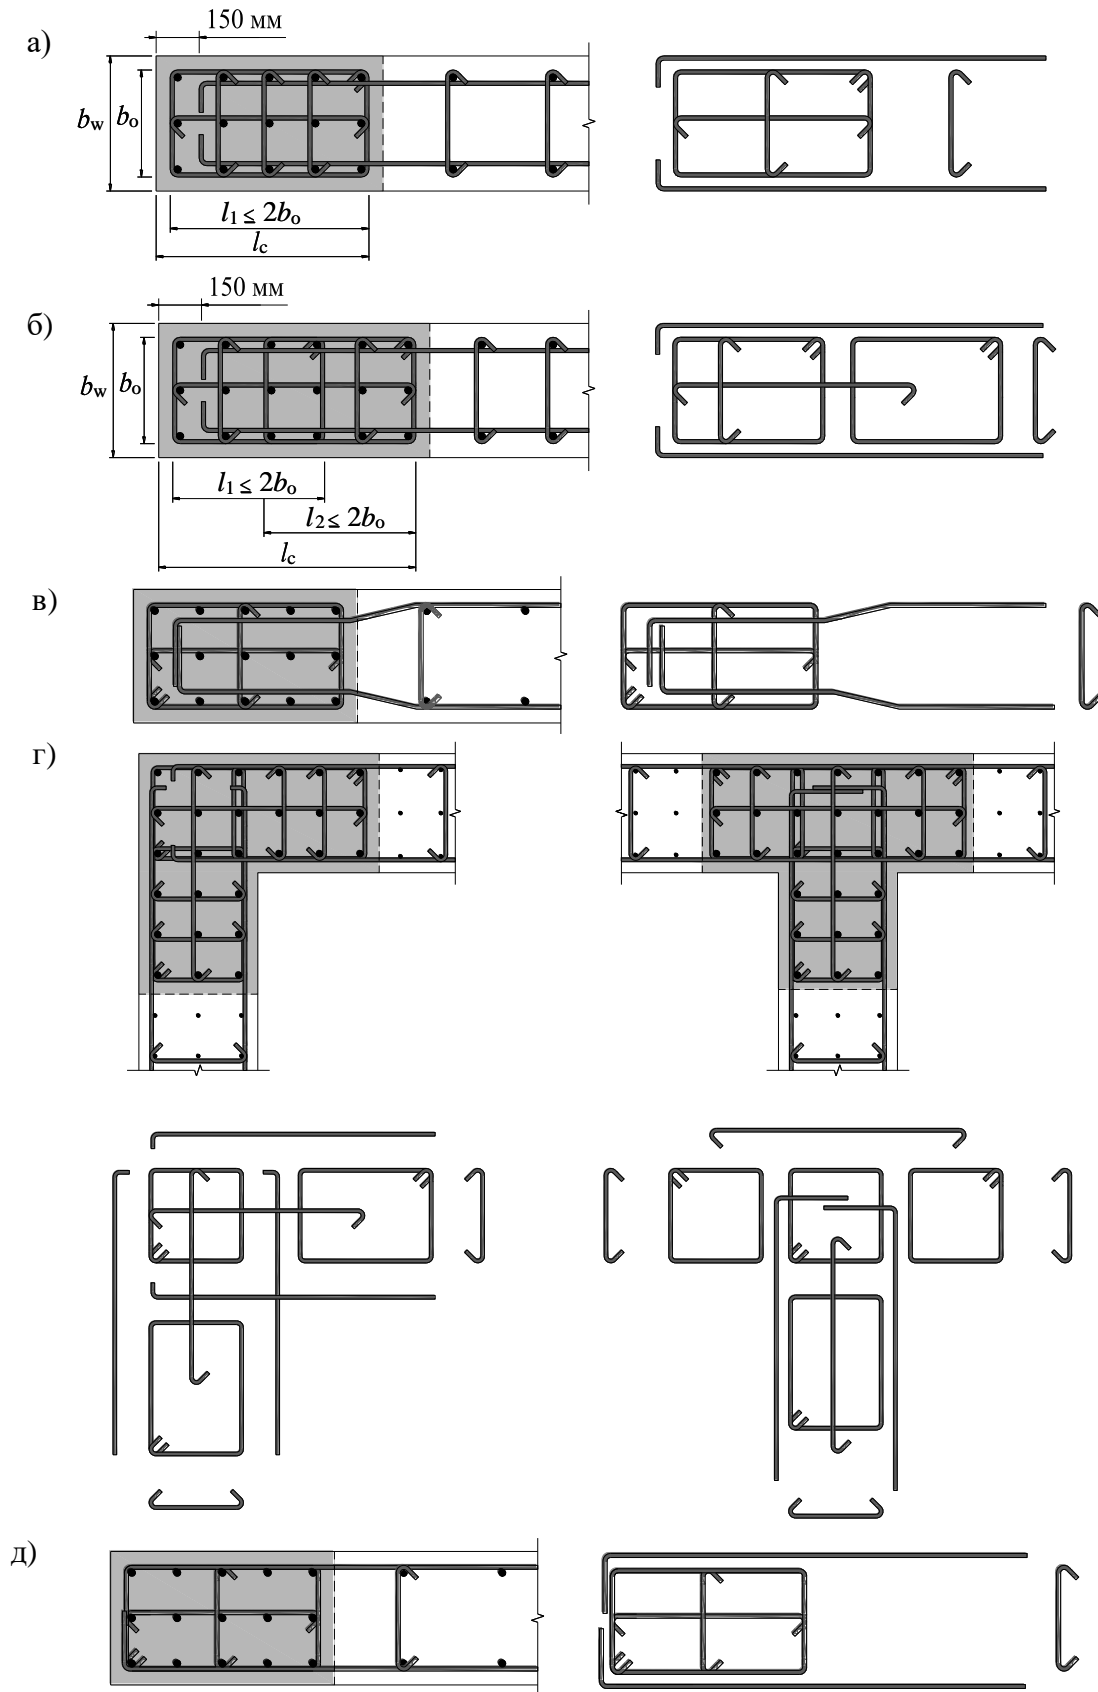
Принципиальные схемы армирования периферийных участков стен
